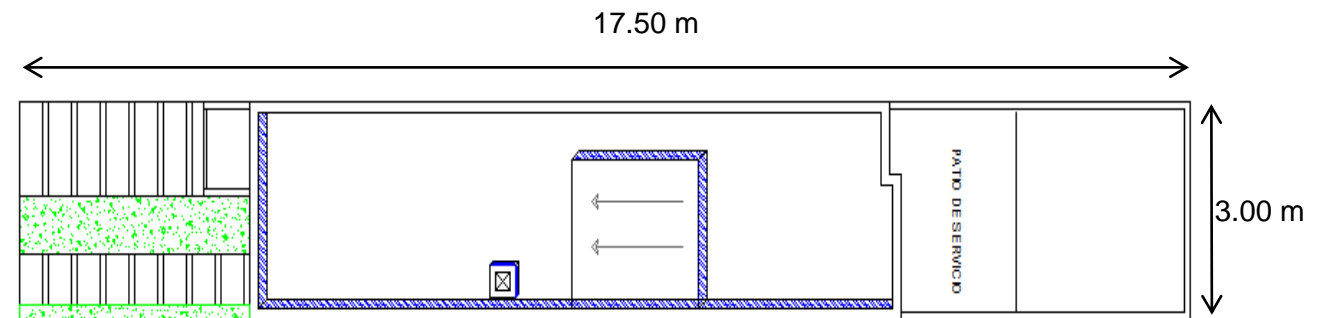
Dimensiones y forma de la casa a estudio. Fuente: Equipo tesis
